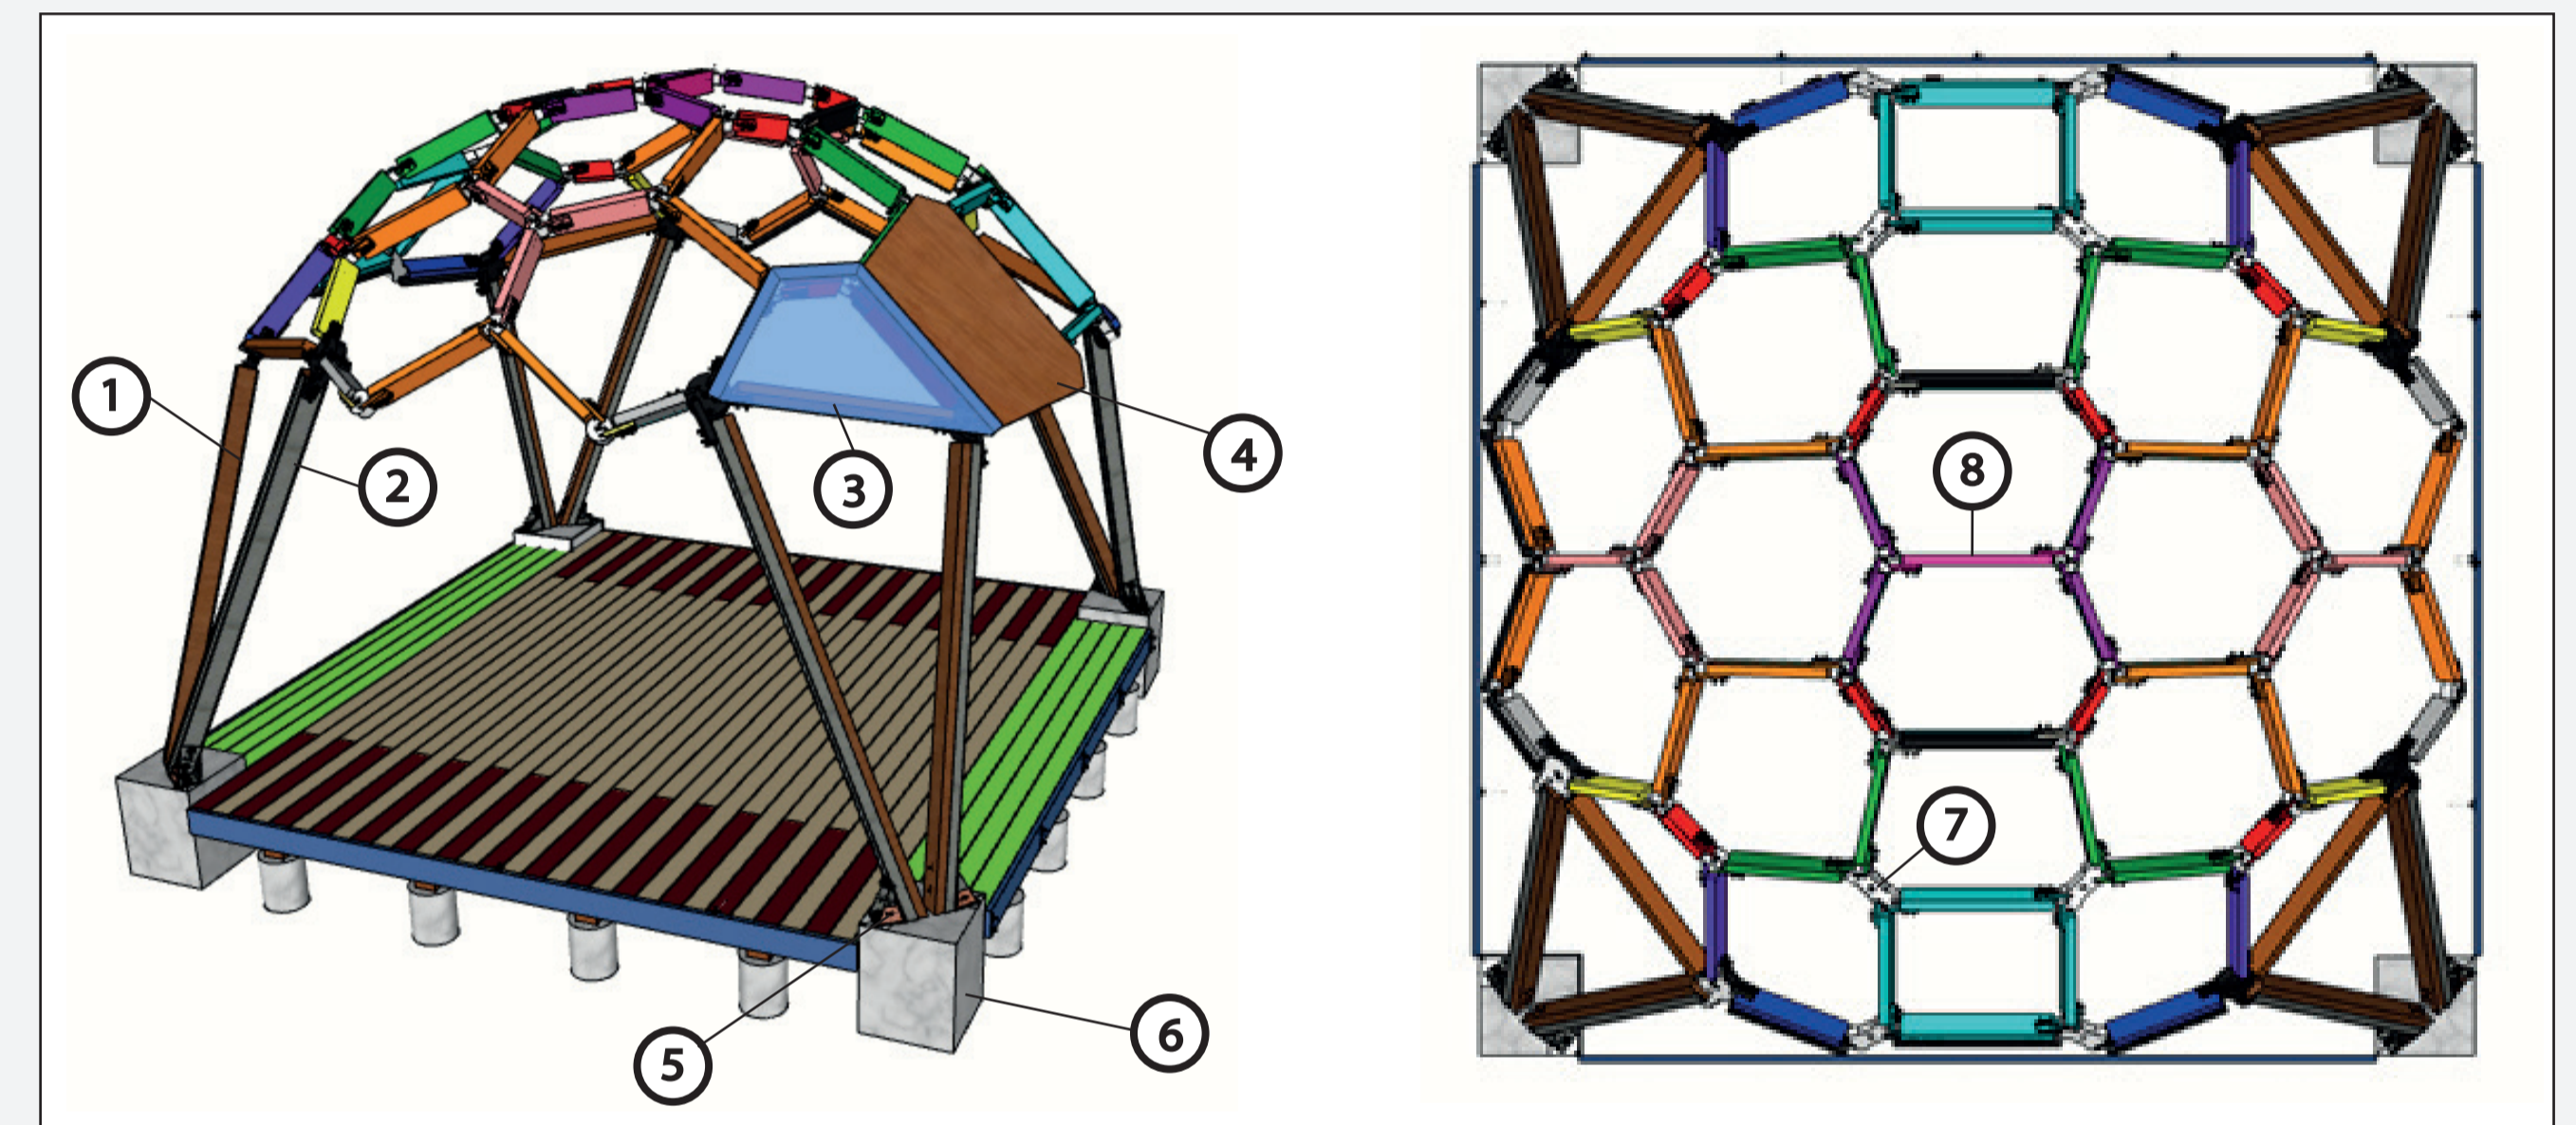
Distribución espacial de los elementos estructurales; (1) Viga 4"x 4"; (2) Perfil tipo C 100x50x2 mm; (3) Sección de acrílico 4 mm de espesor; (4) Sección de terciado estructural de 15 mm de espesor; (5) Soporte de acero inclinado fabricado con pletinas de 10 cm de ancho y 5 mm de espesor; (6) Cimiento de concreto de área 40x40 cm; (7) Conectores de terciado estructural de 45 mm de espesor; (8) Viga de madera 2"x 4".
